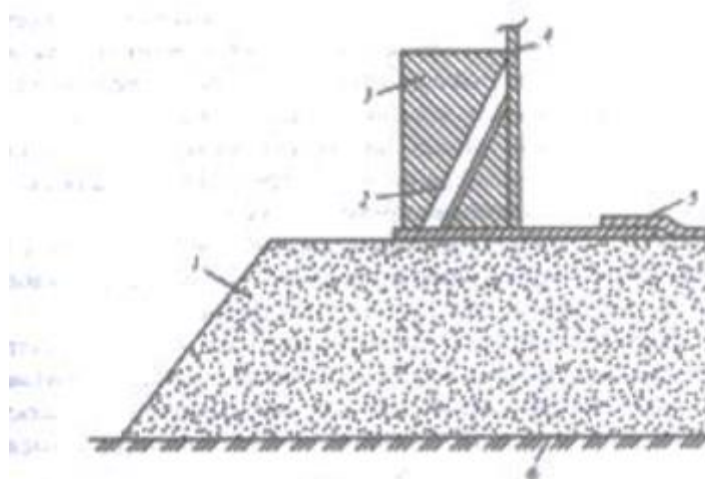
Усиление узла примыкания стенки к днищу: 1 – песчаная подсыпка; 2 – раскосы; 3 – железобетонное кольцо; 4 – стенка РВС; 5 – днище РВС; 6 – основание. [6]
